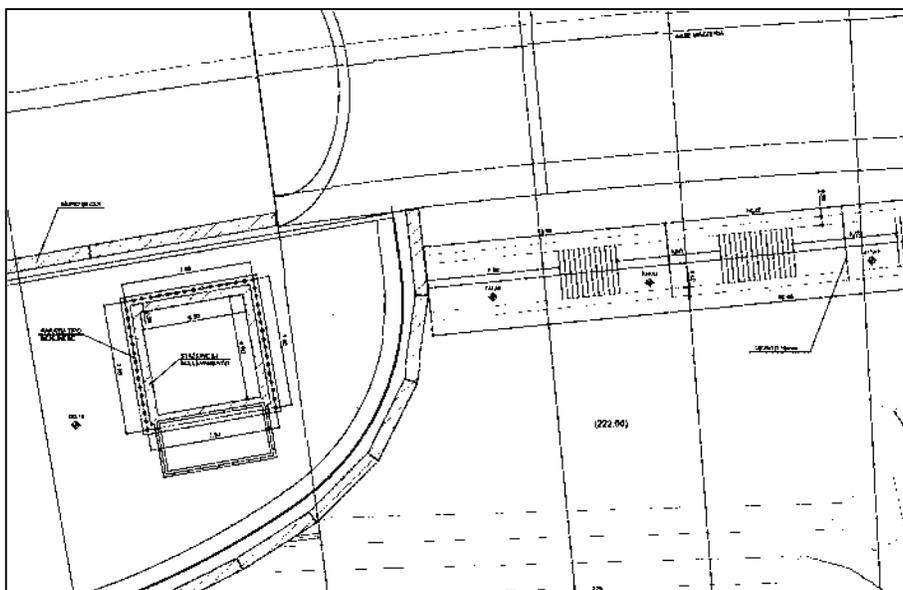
Stazione di sollevamento 1 – Ubicazione planimetrica
